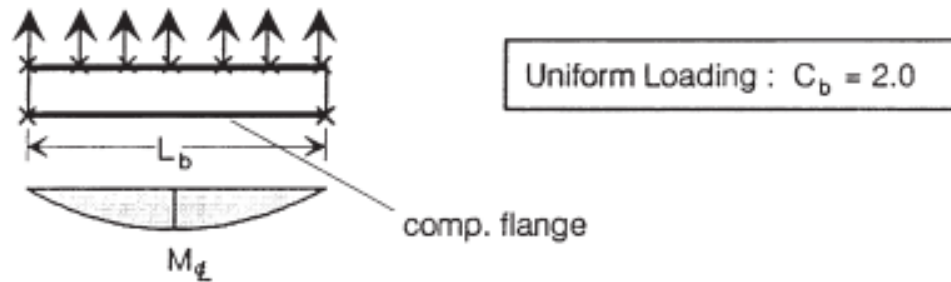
Cas d'une poutre avec maintien continu au niveau de la semelle tendue [6]
